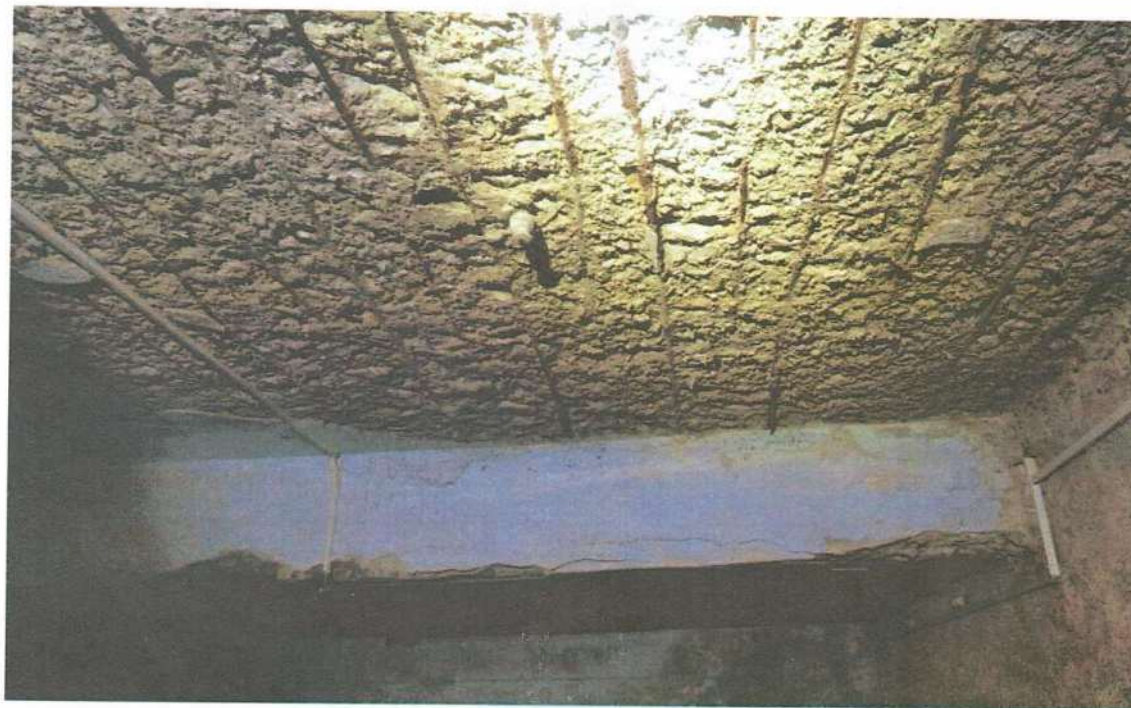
Разрушение защитного слоя бетона перекрытия подвала – арматура монолитной плиты перекрытия обнажена и корродирована.
